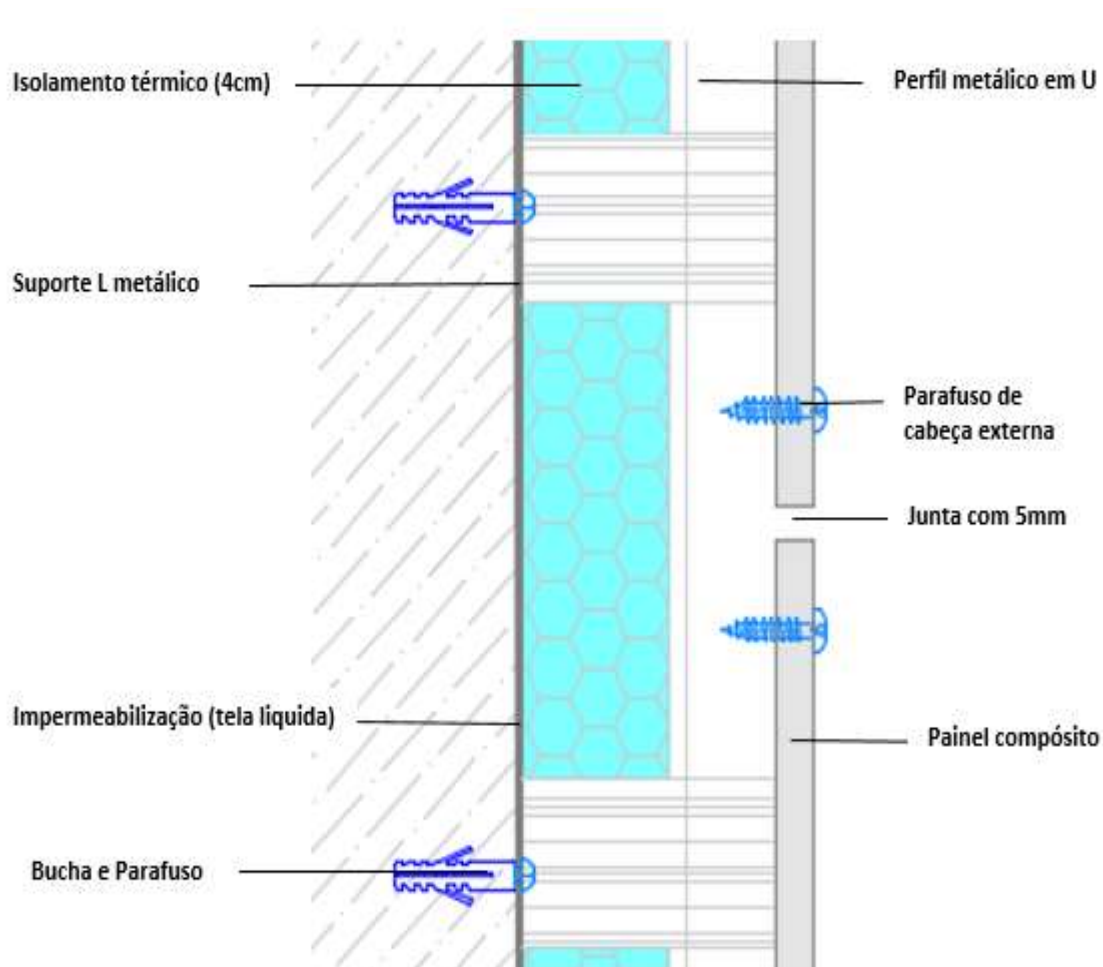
Pormenor construtivo nº 1, seção vertical.
